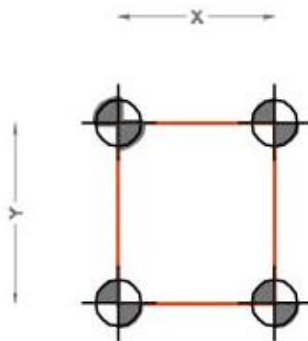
Losa de cimentación apoyada en columnas Mixpile®
